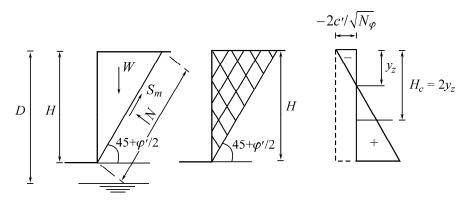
Критическая высота выемки без крепления стенок в ненасыщенном грунте
